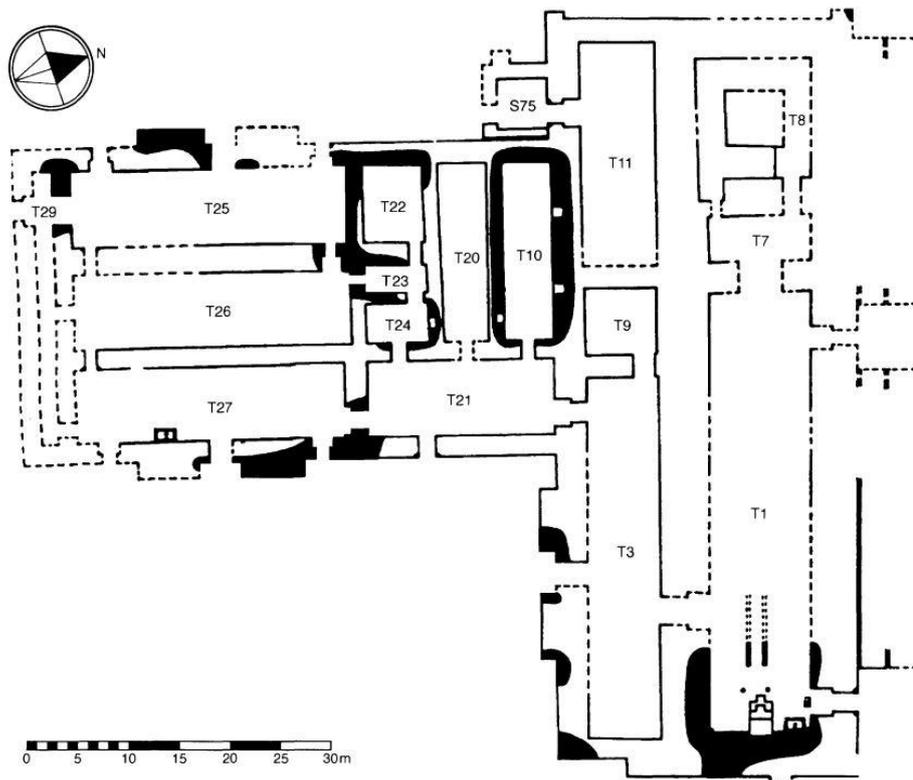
Detalhe da planta do Forte Shalmaneser.
